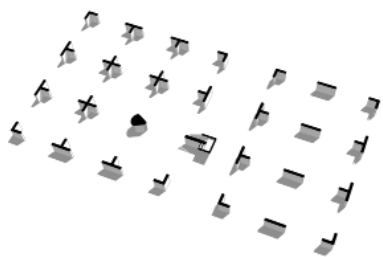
Isometría de la estructura de muros pantalla. Fuente: MCHS.
